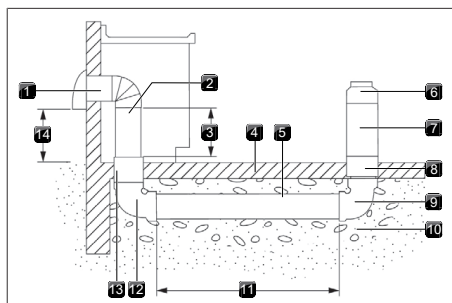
Installations sur dalle de béton – évacuation murale
